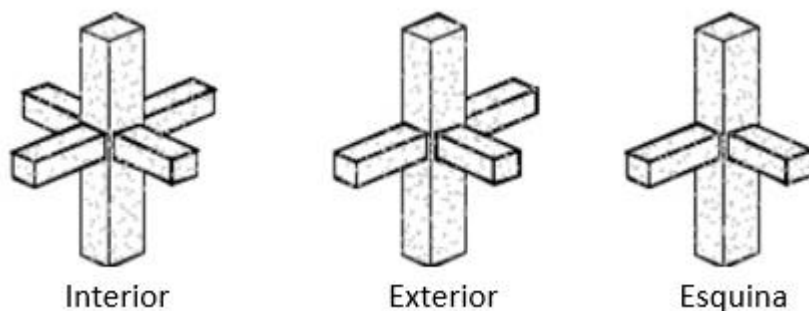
Tipos de unión viga-columna. (Roberto Aguiar, Mary Revelo, Willy Tapia)
